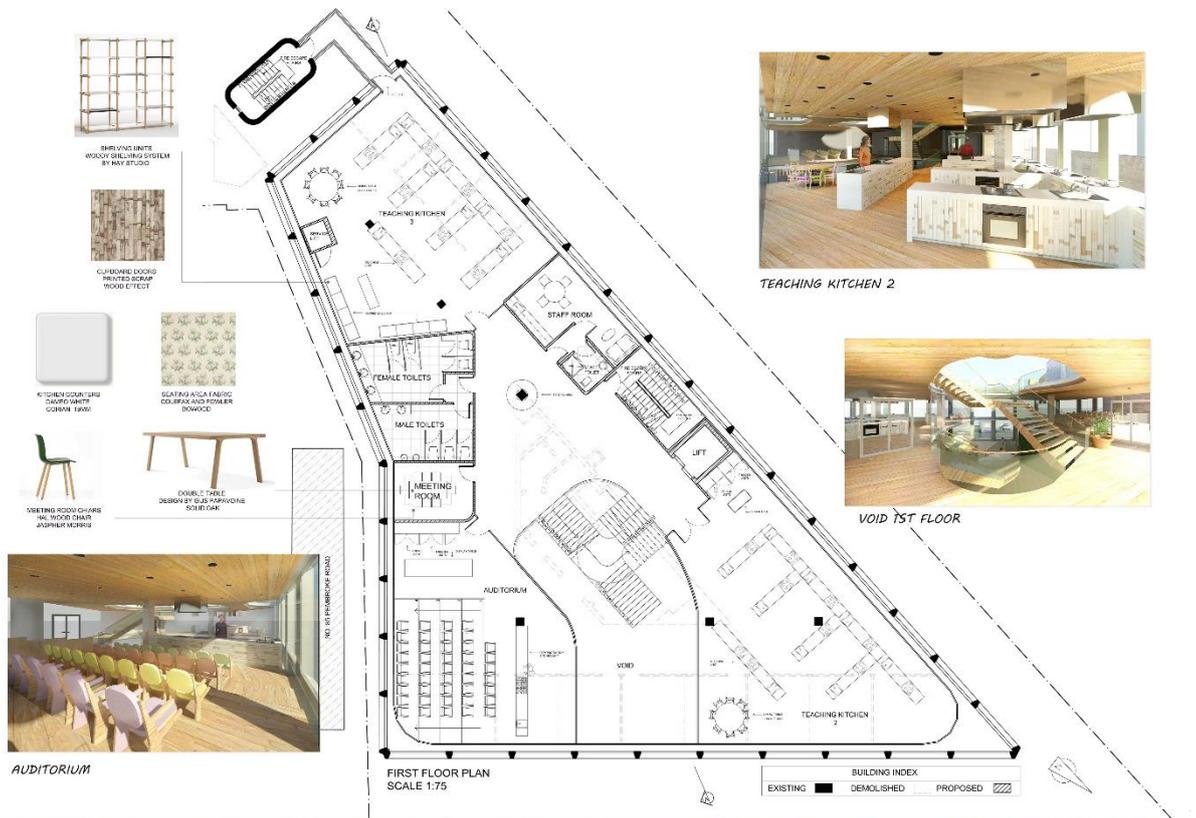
Referente Arquitectónico d4 Kitchen Plantas
